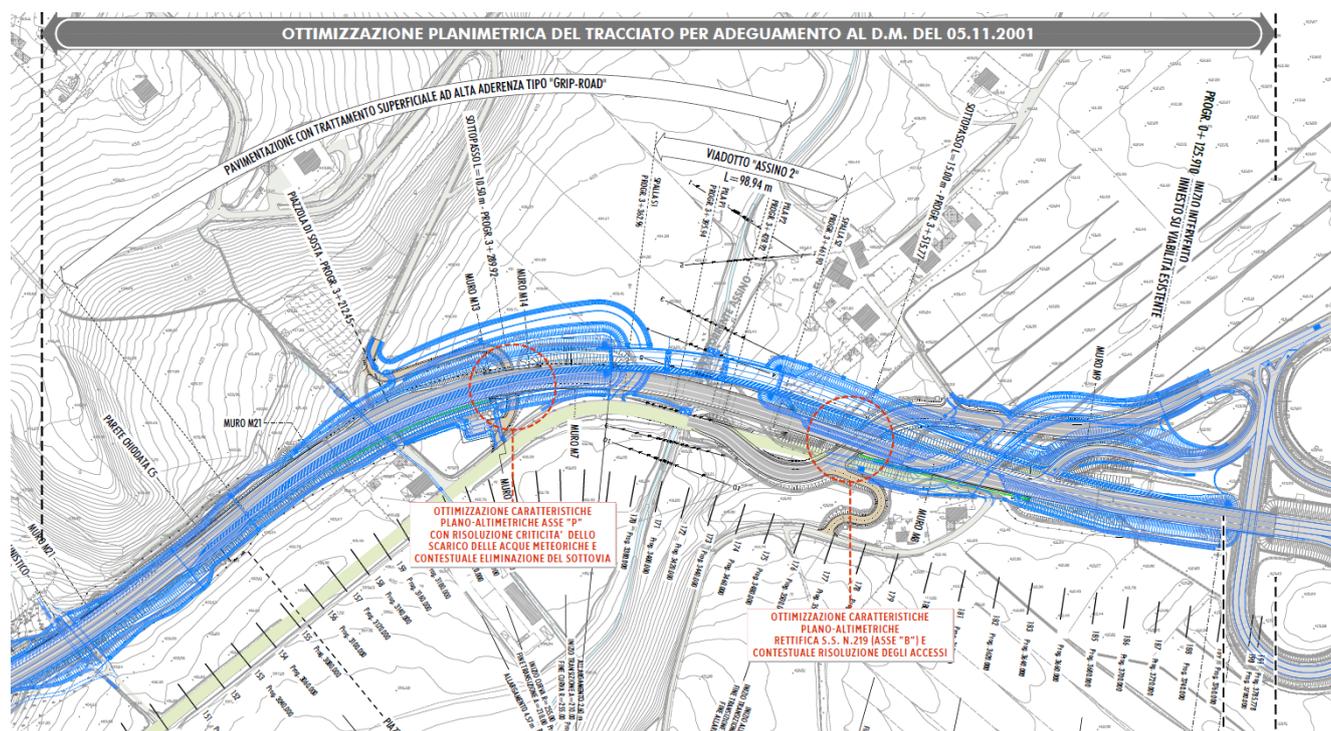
PLANIMETRIA DI RAFFRONTO CON IL TRACCIATO DEL PROGETTO DEFINITIVO IN CORRISPONDENZA DEL VIADOTTO ASSINO 2
